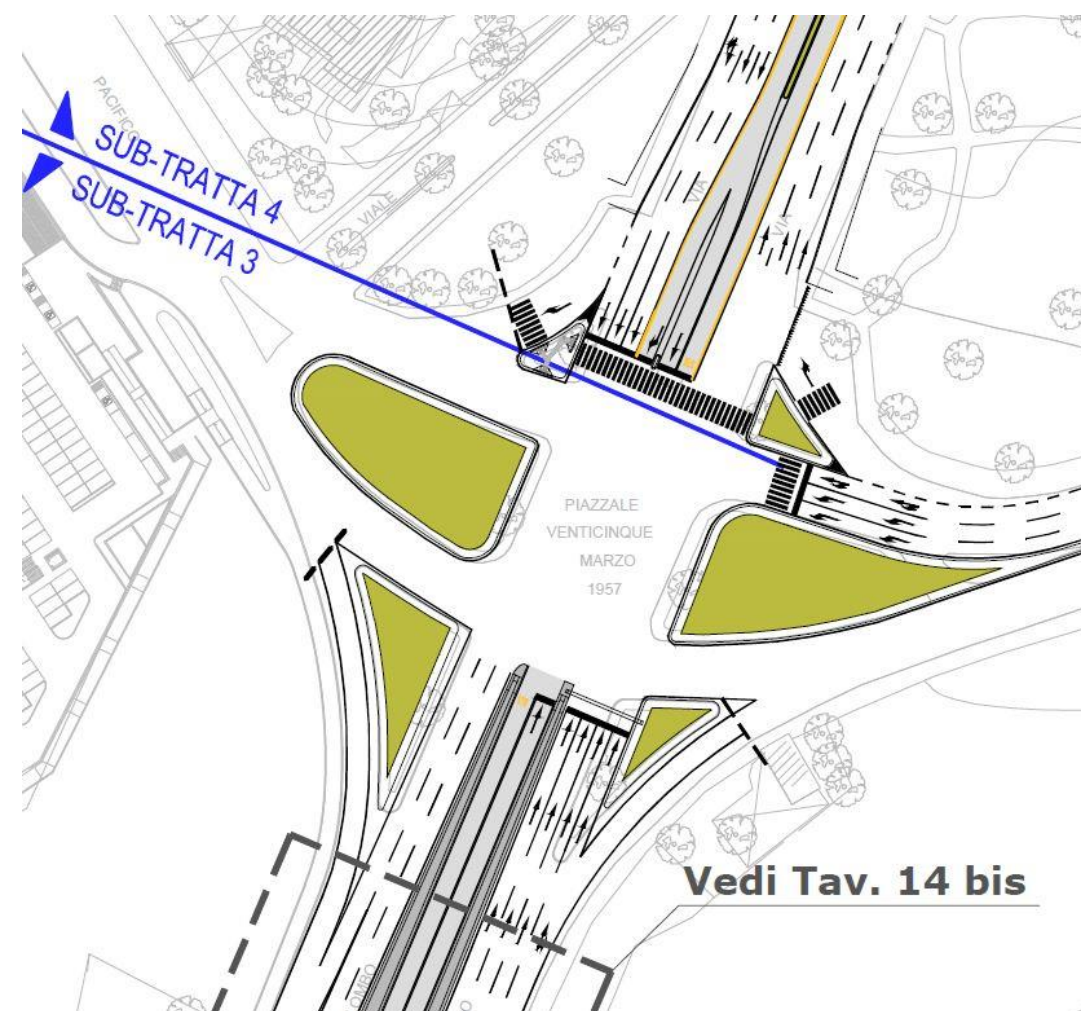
aggiornamento stralcio planimetrico sistemazione piazzale XV Marzo 1957
